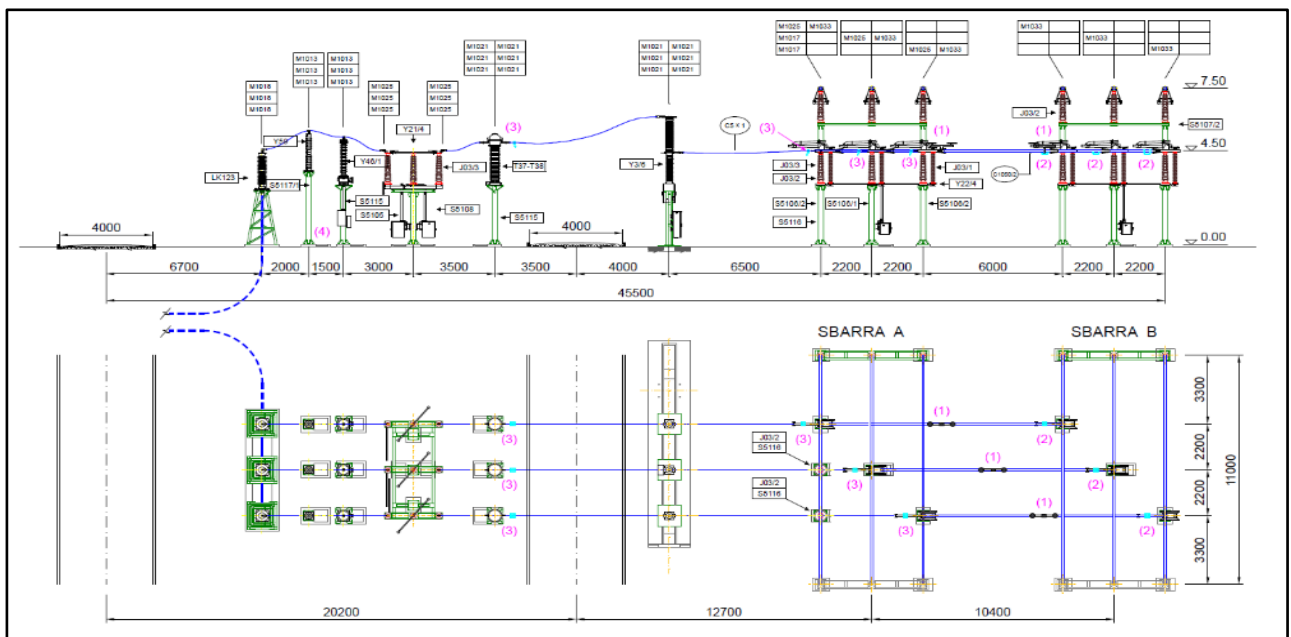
Planimetria e sezione elettromeccanica relativa alle apparecchiature dello stallo 150 kV nella stazione Terna
